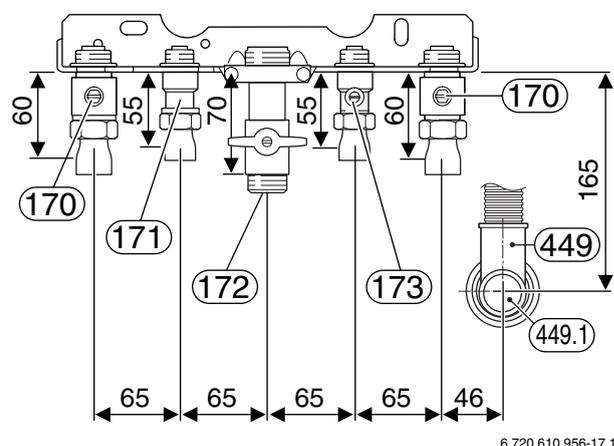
Panneau de raccordement et de montage (installation terminée) pour GVS
